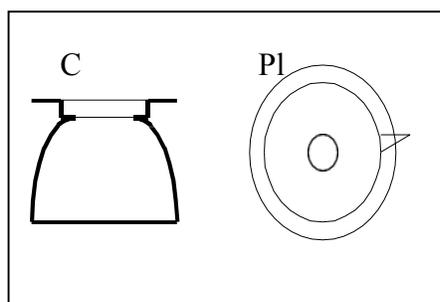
Planta y Alzado de hábitad Excavado en China. Fuente: Loubes, 1985.
